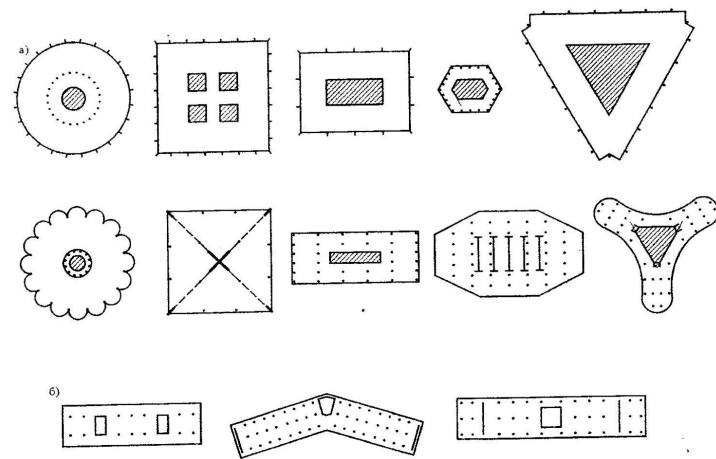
Ствольные здания: схемы, формы и размещение внутренних жестких элементов закрытого и открытого сечения: а - в башенных, б - в протяженных зданиях
